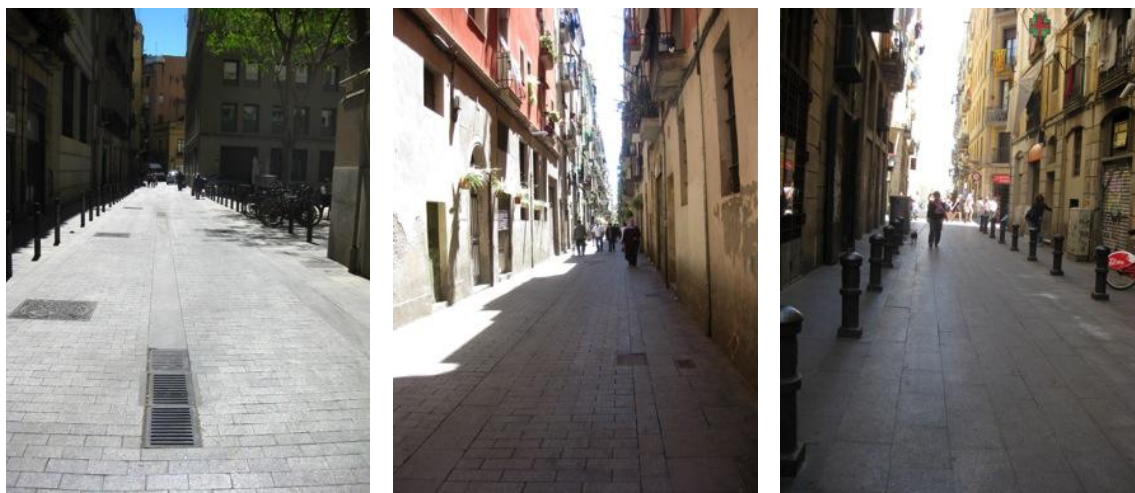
> Distintas calles del barrio de Santa Caterina y del Raval pavimentados a nivel con losas o adoquines de granito
